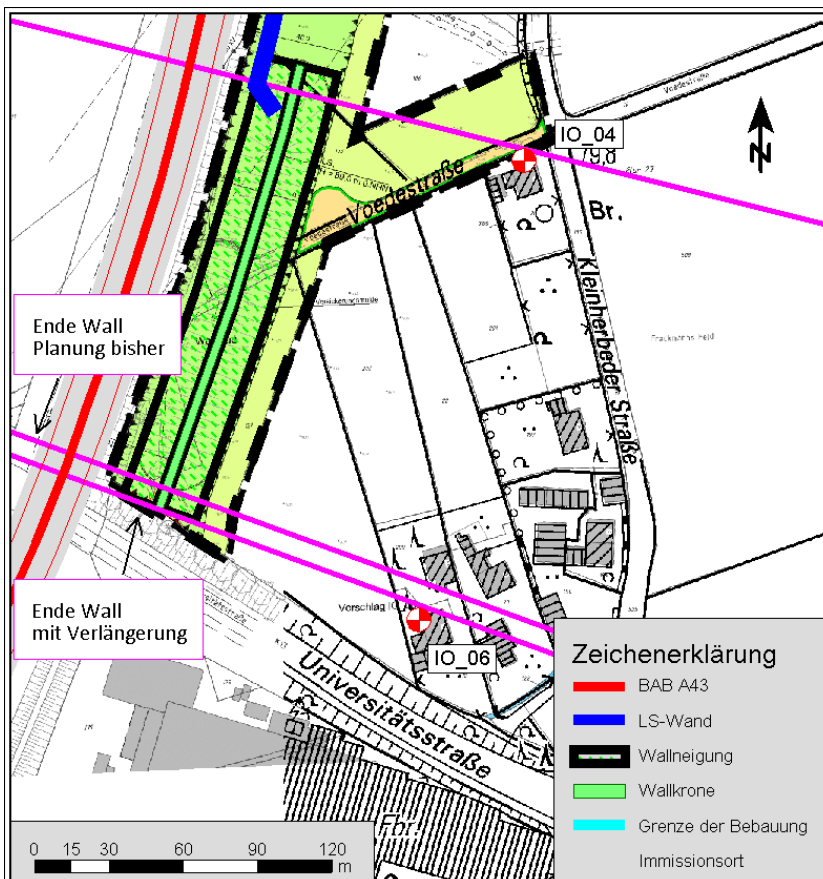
Lageplan südlicher Abschnitt des Walls mit Verlängerung
